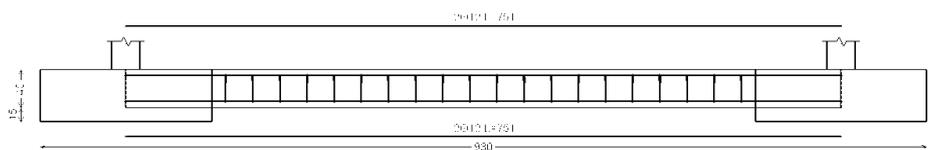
Vista viga de atado (Fuente: CypeCad)
